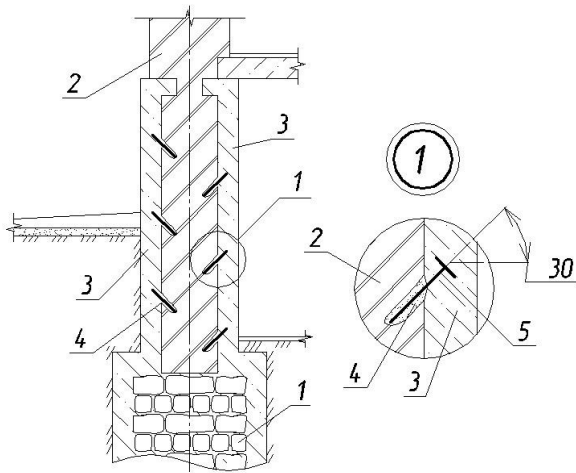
Закріплення стін підвалу й фундаменту улаштуванням обойми з фібробетону:
